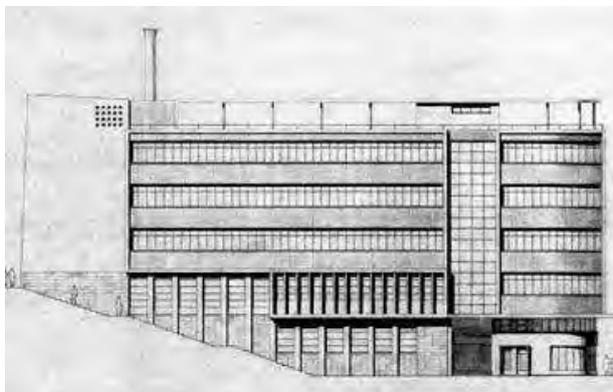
"Ante-Projecto das Novas Instalações da Garage do Conde Barão Ldª a construir na Avª 24 de Julho - alçado poente" (1951) (Fonte: JA 251, Ser Belo)
